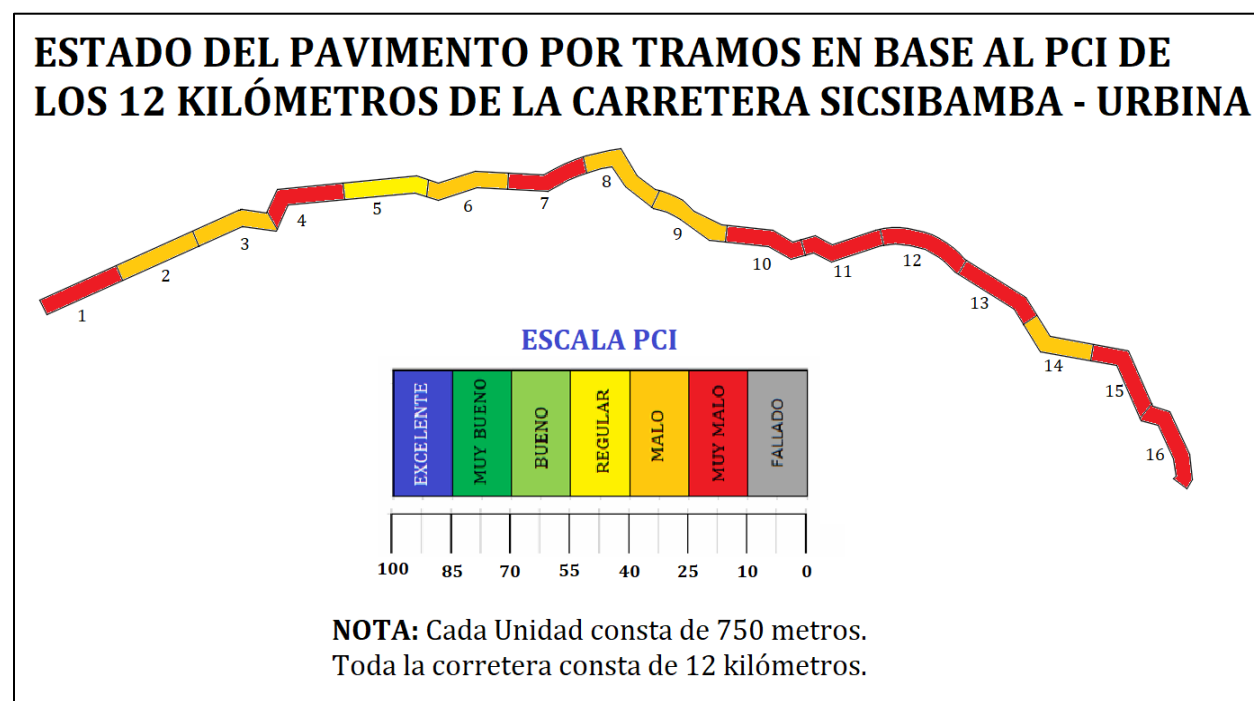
Estado del pavimento en base al PCI - Fuente: Elaboración Propia
